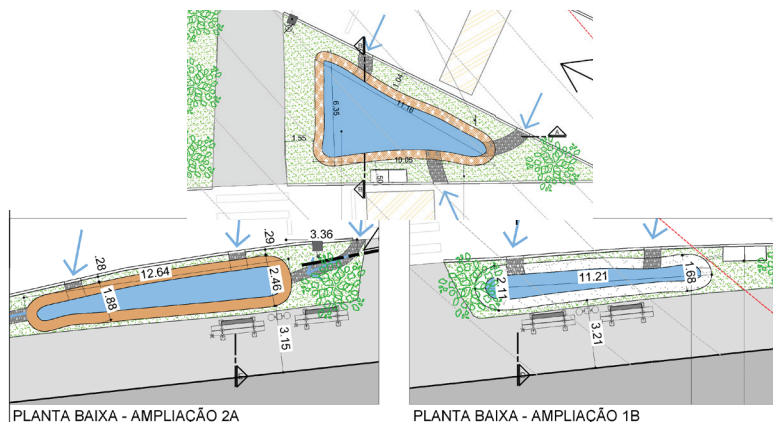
Detalhamento jardins de chuva implantados na região da Escola Classe do Setor P Norte
